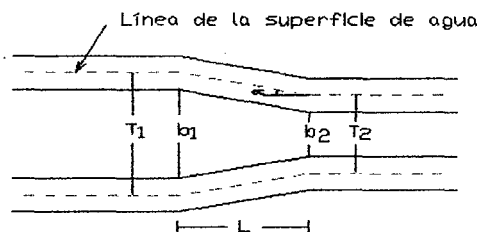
VISTA EN PLANTA DE UNA TRANSICIÓN
